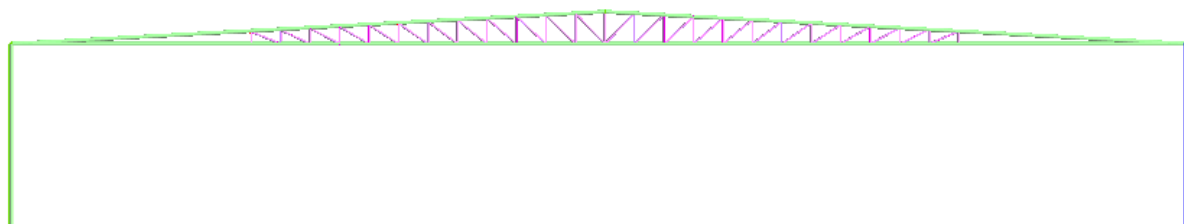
Esquema do pórtico “tipo” alternativo com travessa plana
